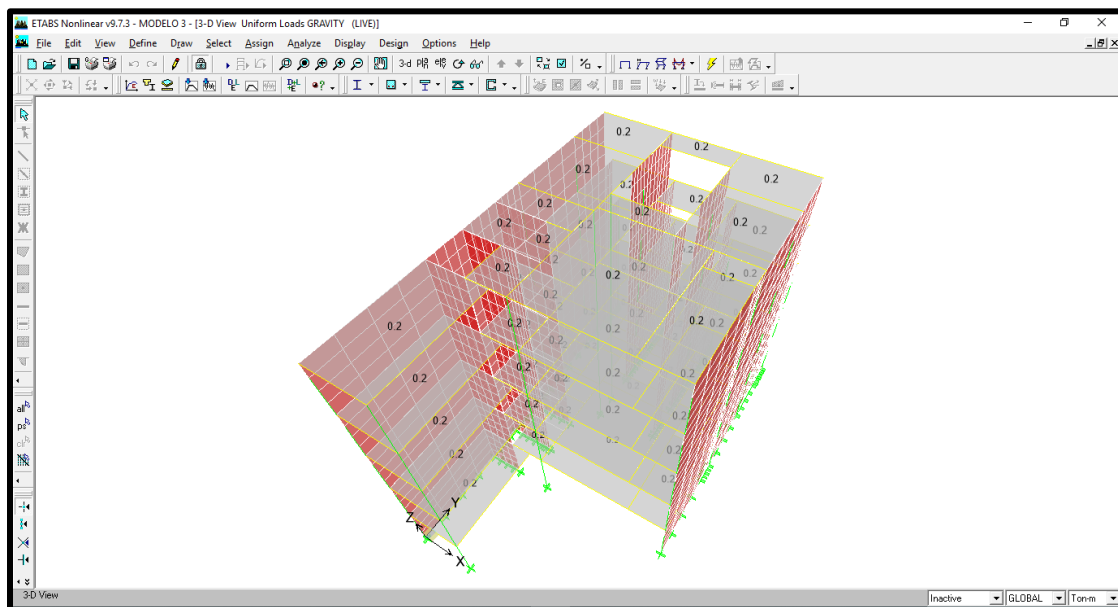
Carga Viva (L) aplicada a las losas (Ton/m²). Sobrecargas asignadas a la estructura, correspondiente a las cargas asignadas a las losas, internamente el programa distribuye estas últimas a las vigas y estas a su vez a las columnas.
